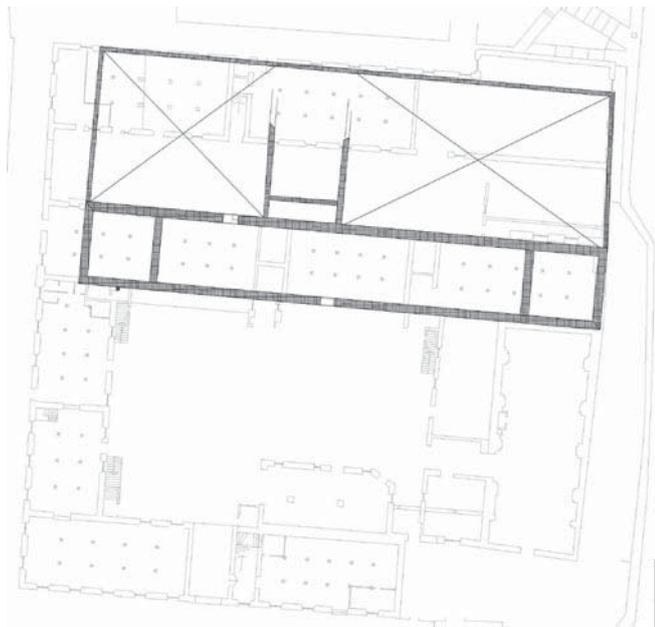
Restitución de la planta del Colegio de San Laureano (Fase I).
